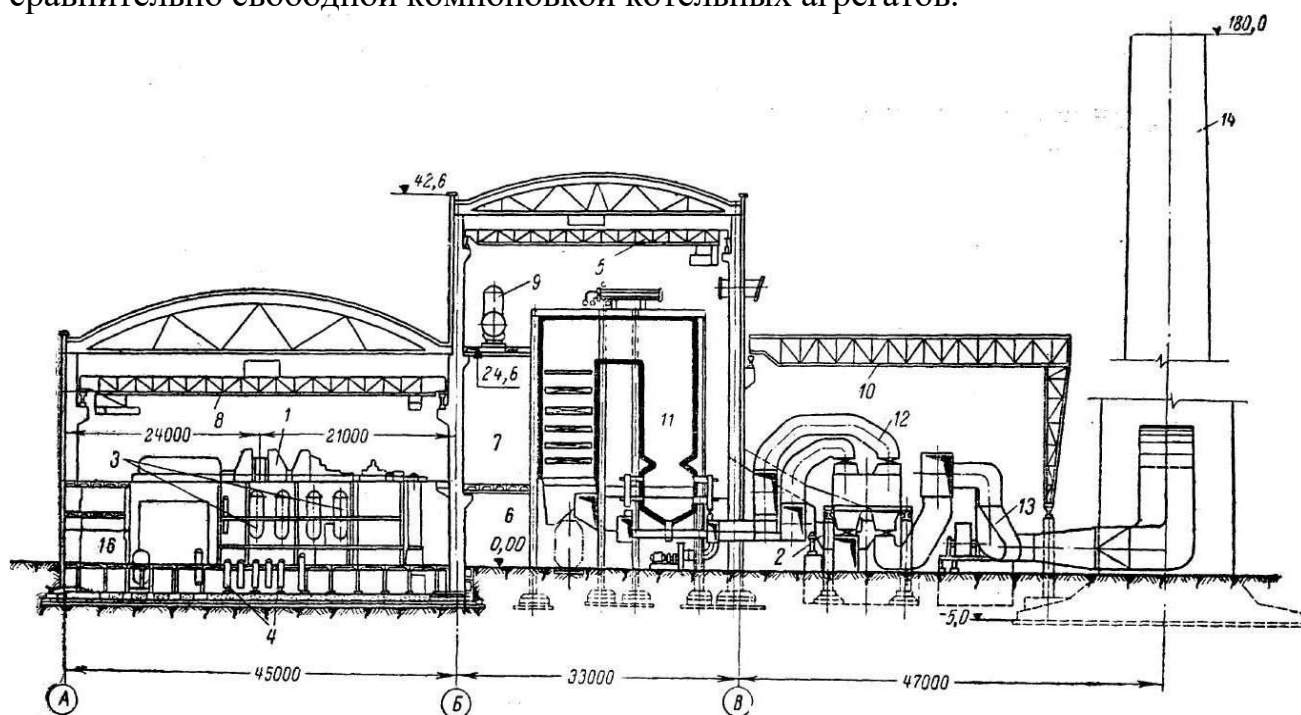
Компоновка главного корпуса с разворотом топки газомазутного котла к наружной стене (поперечный разрез):
